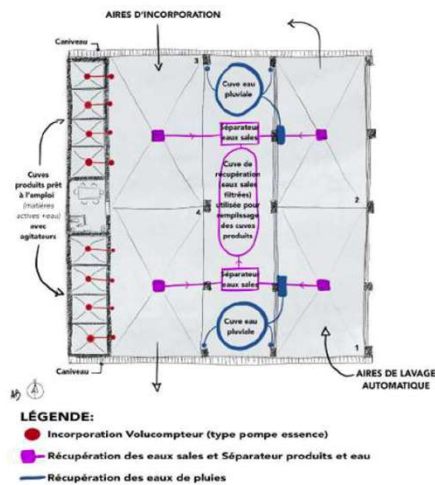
Plan d'une station de lavage et d'incorporation collective. Crédits dessin Alexandra Belle.
